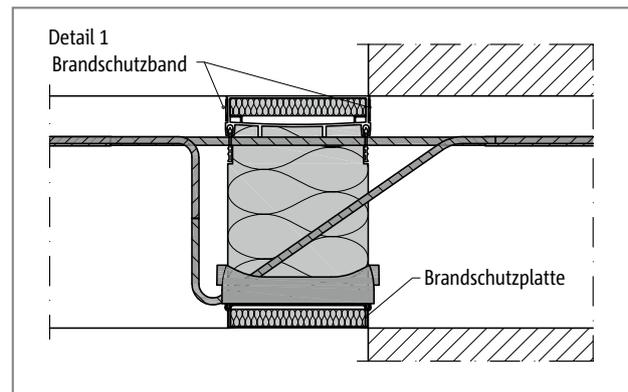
Schöck Isokorb® XT Typ KL bei REI120: Detail 1
